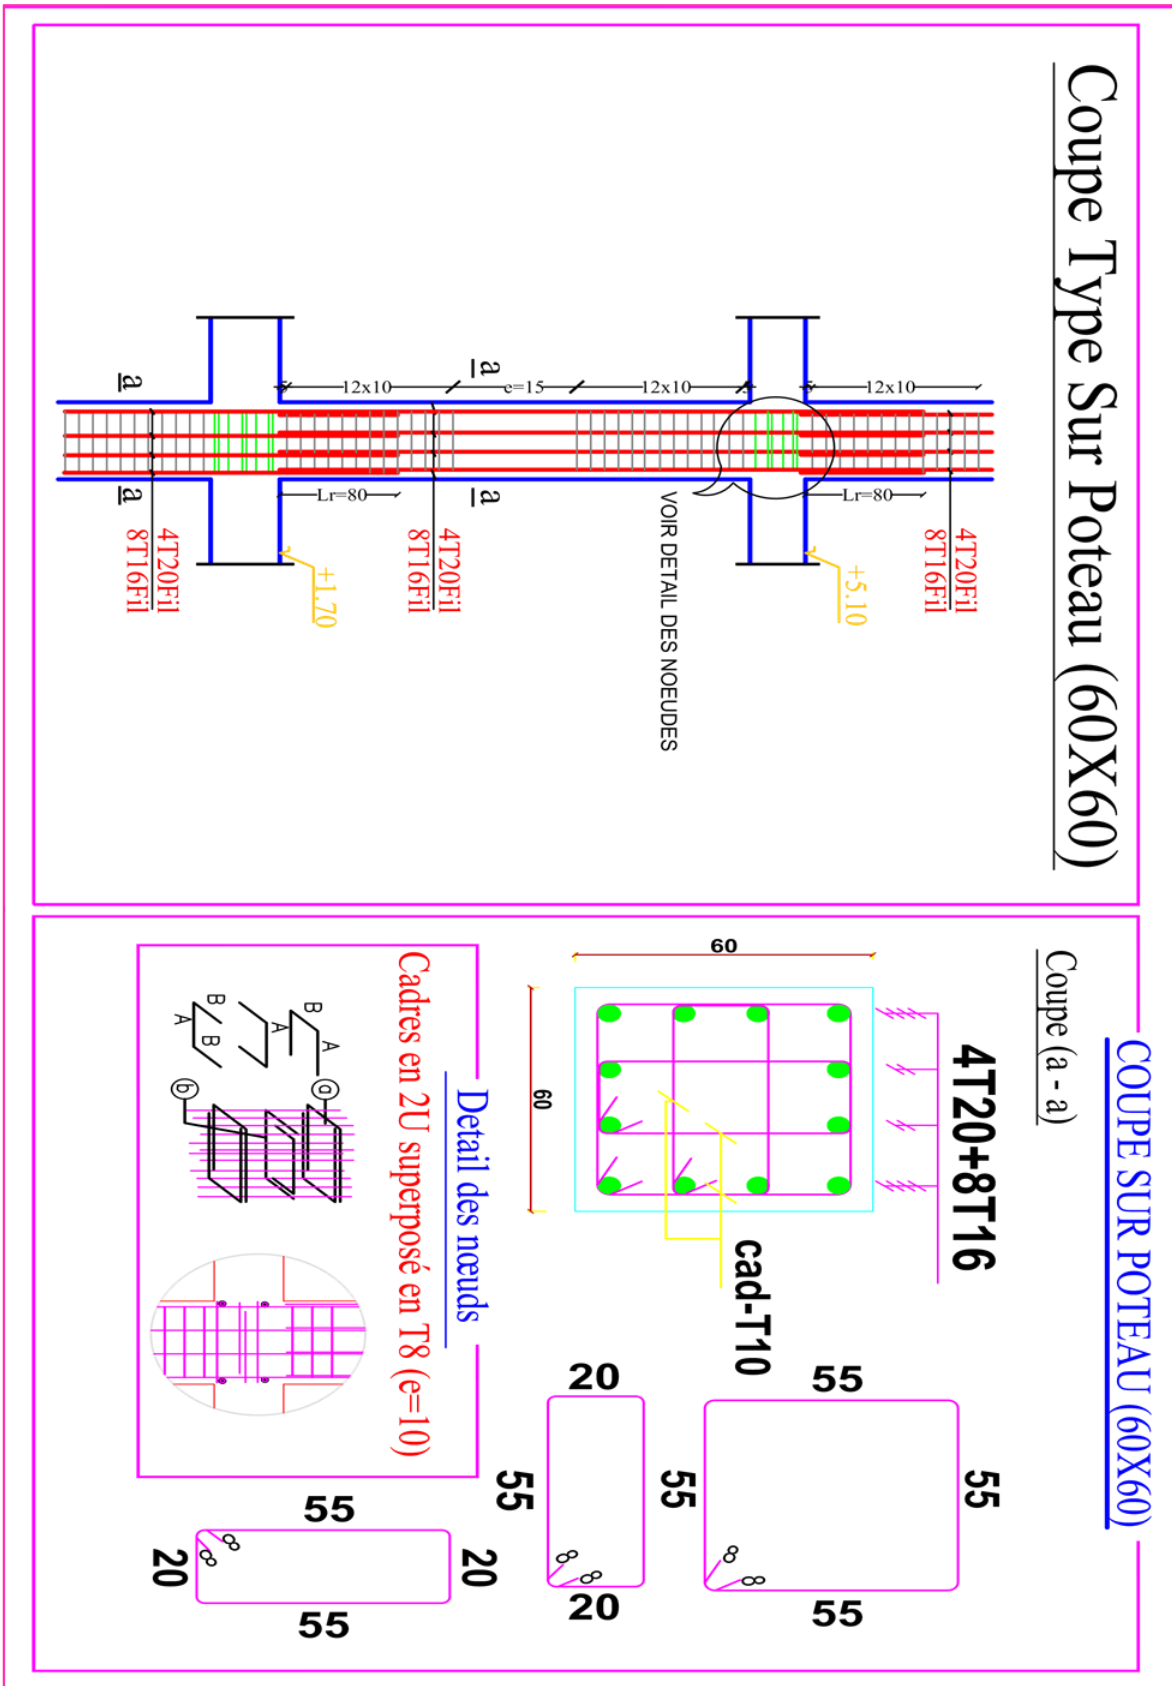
Schéma de ferrailage des poteaux (60x60)
